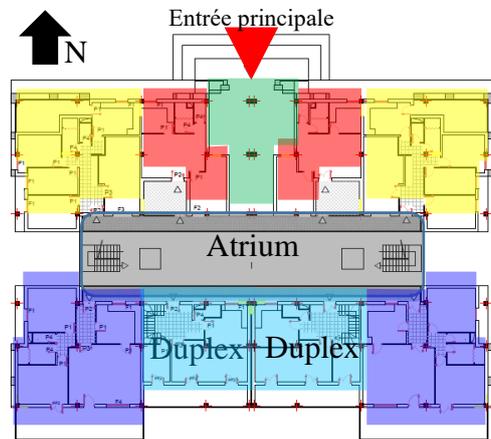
plan de RDC/ 1^{ere} étage source auteur
